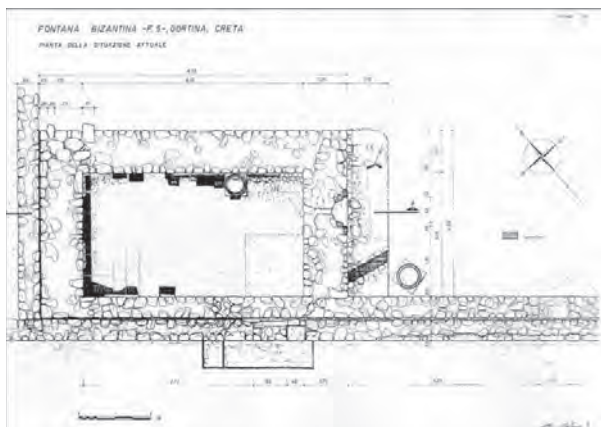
Planimetria della cisterna/fontana nr. 85 (A. Ortega 1989, Archivio SAIA).
